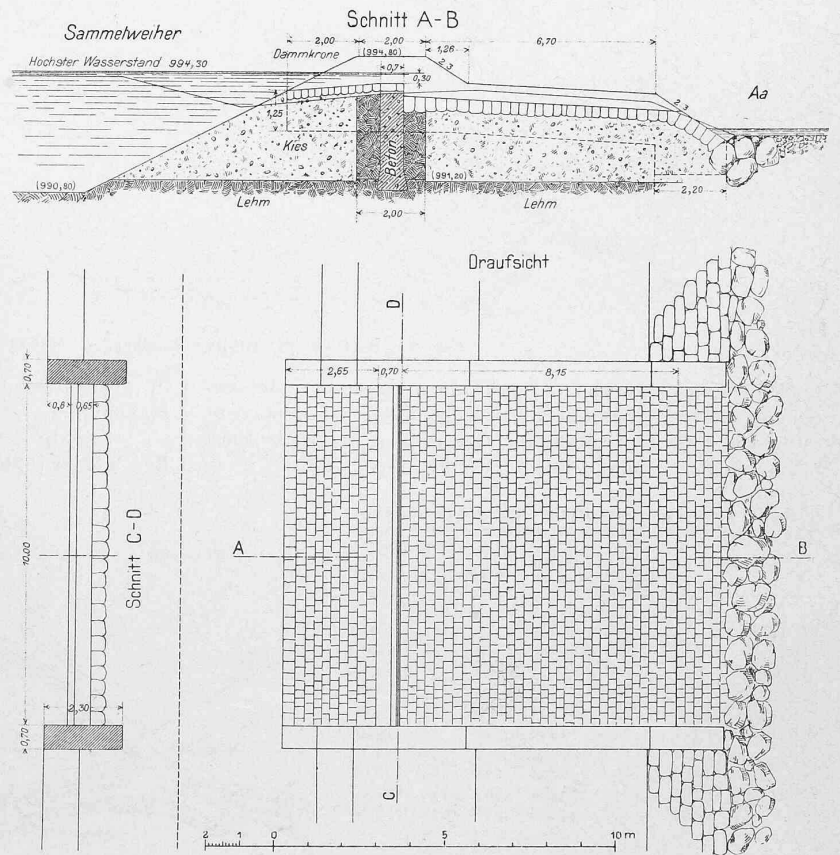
Ueberlauf aus dem Sammelweiher. Grundriss und Schnitt. — 1:200.
